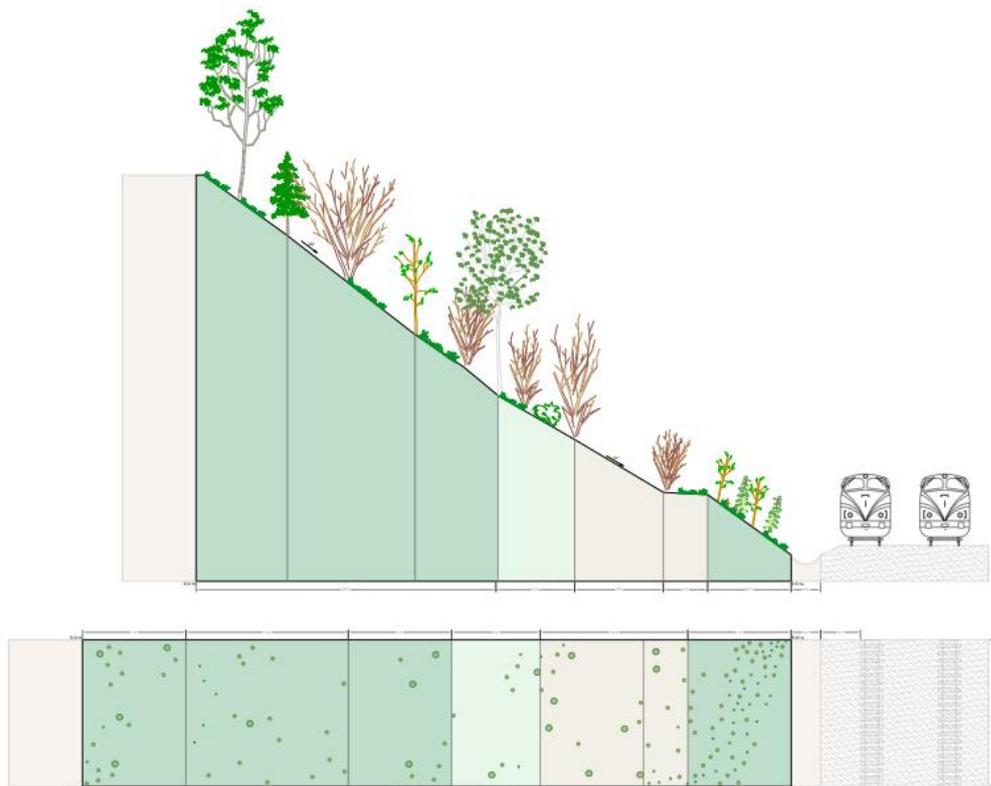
Fläche 9.1 – Querschnitt und Grundriss.
